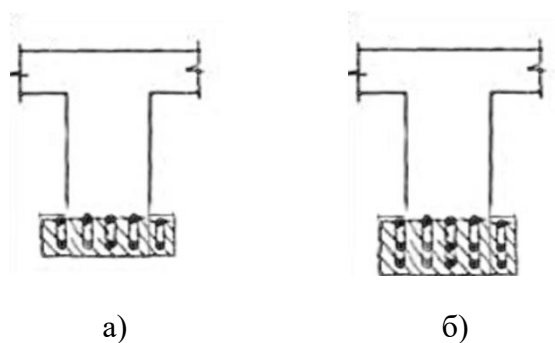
Сечение железобетонной балки до усиления (а), сечение железобетонной балки после усиления (б)
